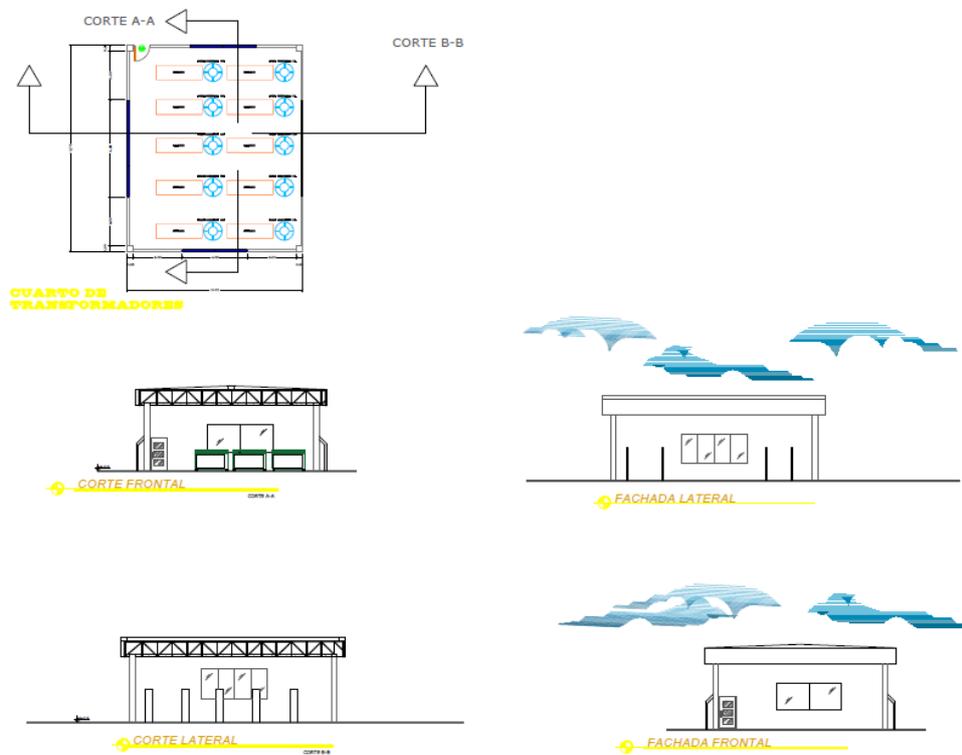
Planta arquitectónica, corte y fachada de andén de recarga
